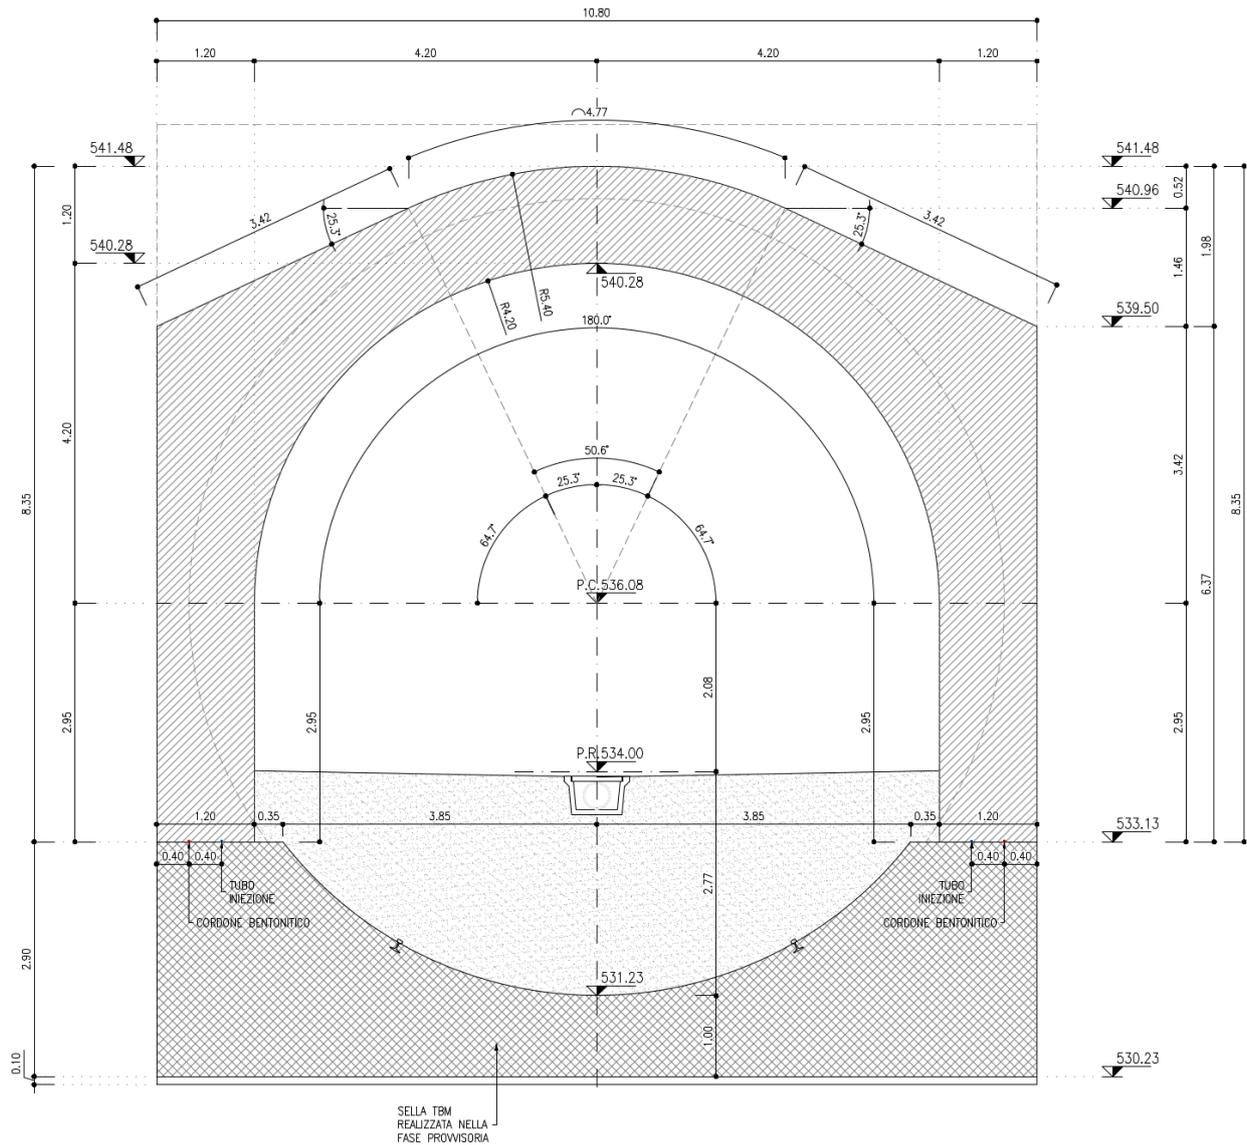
Sezione Trasversale – Becco di Flauto
